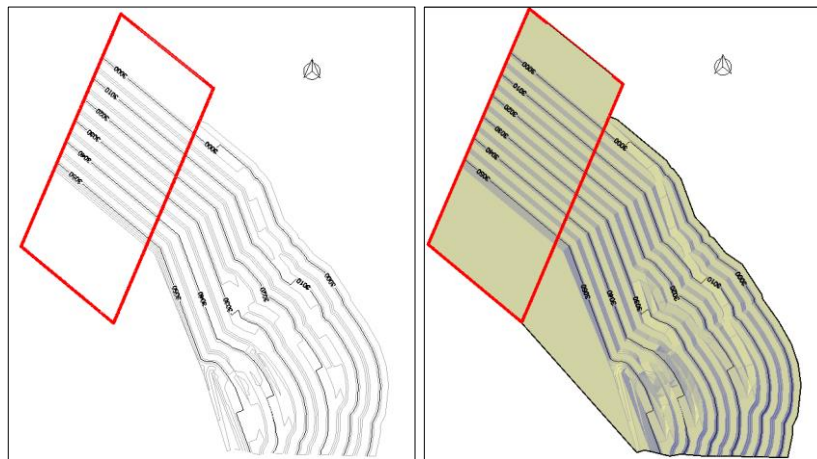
4: Vista en planta y 3D de la primera etapa
